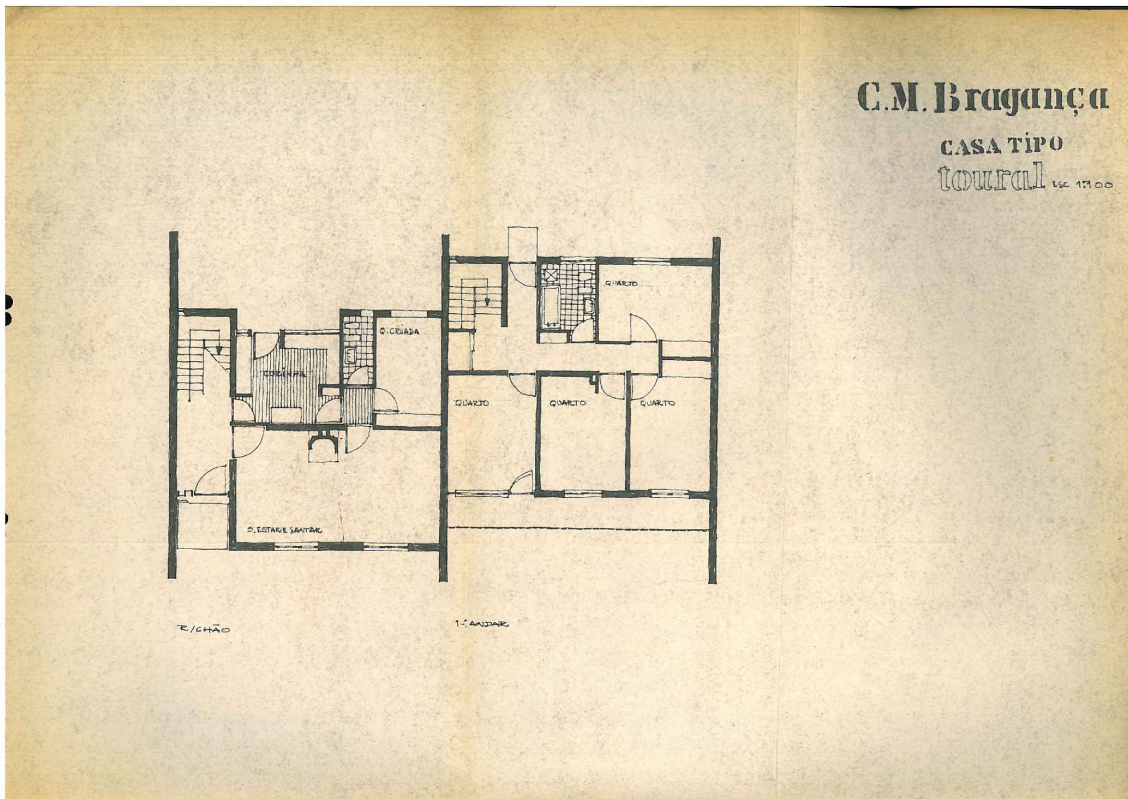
Viana de Lima, planta da casa-tipo, Bairro do Toural, Bragança, 1963
